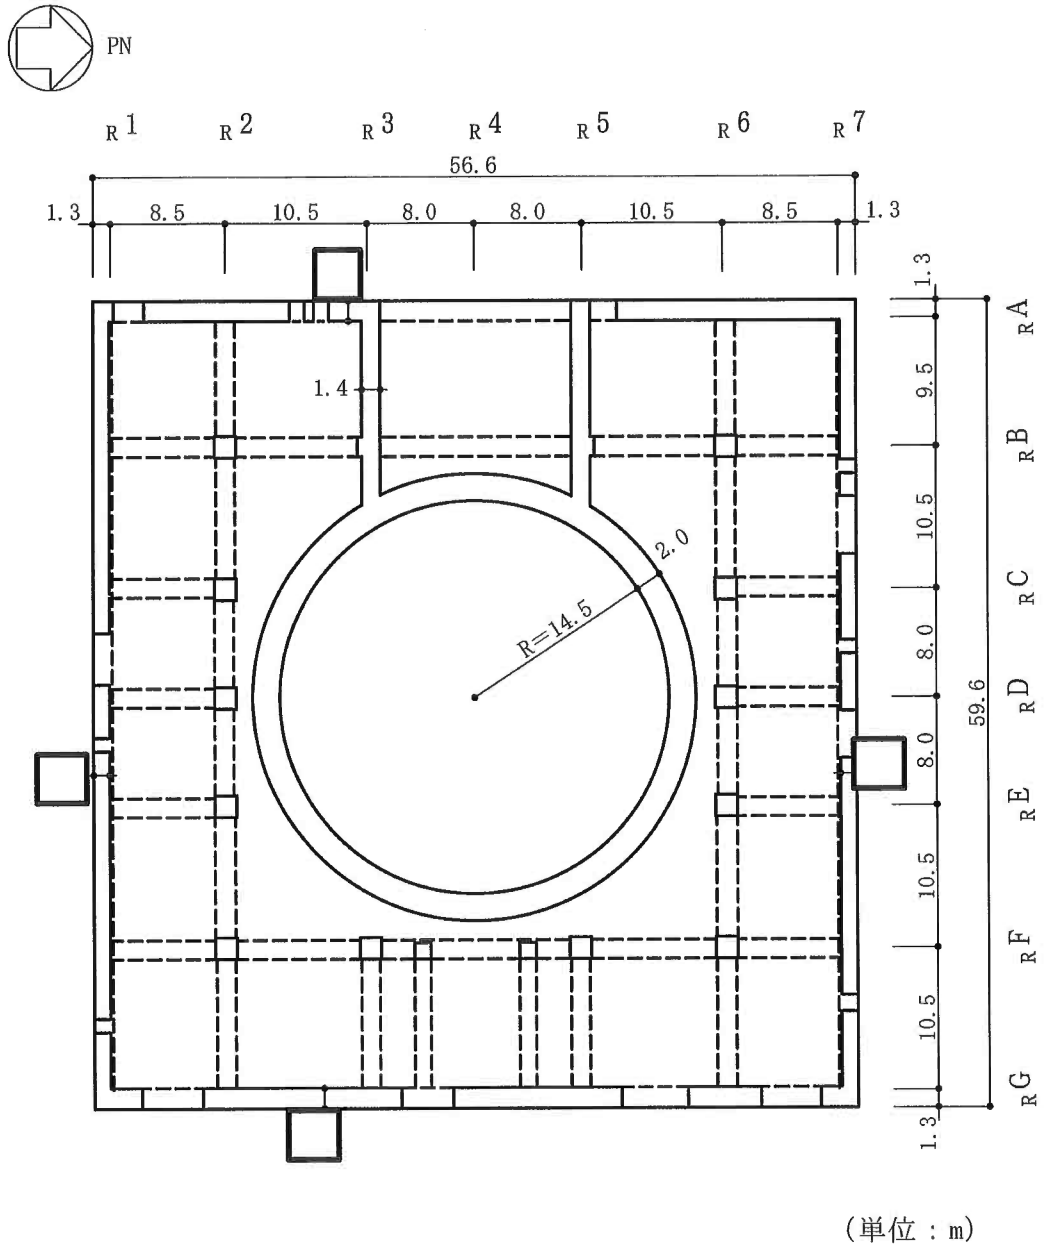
6号機原子炉建屋の概略平面図 (1F, T.M.S.L. 12.3m) (4/9)
